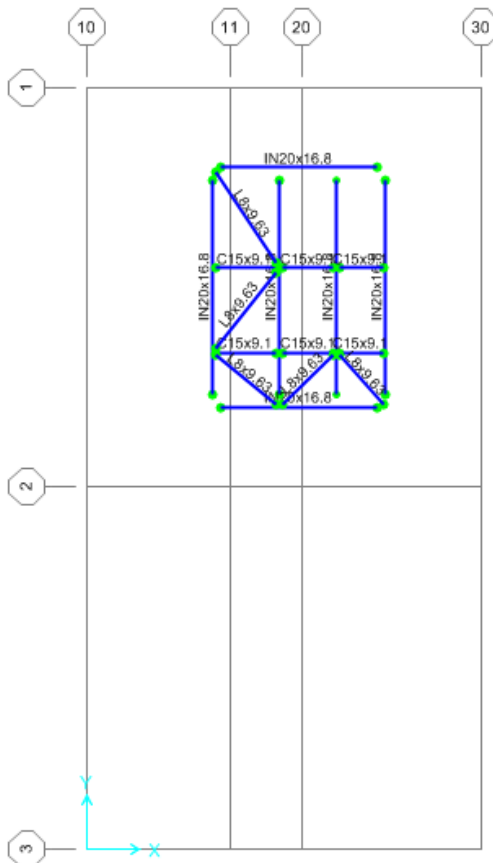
Planta Elevación 2.85 m sobre el nivel de terreno. En la figura se muestra la distancia entre ejes la cual se omite posteriormente por claridad.
